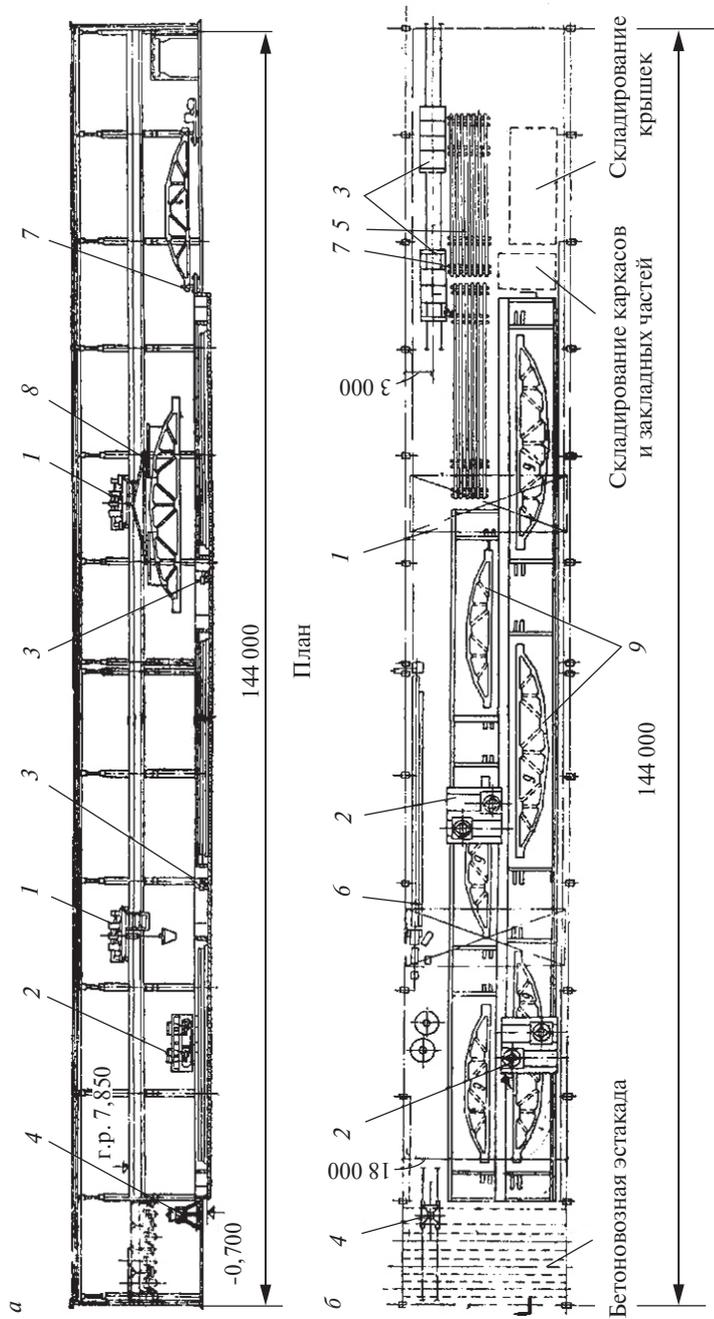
Вариант линии коротких пакетных стенов со стенов-камерами для изготовления раскосных ферм пролетом 18 и 24 м (продольный разрез и план) (а, б):
